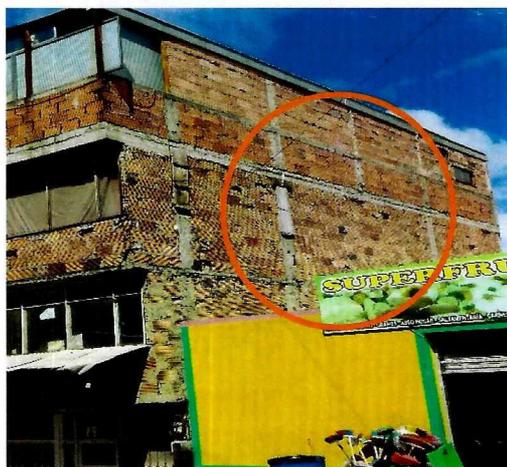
Pérdida de la Continuidad Estructural en las Columnas y en las Vigas del Predio 15 de la Manzana 4.
